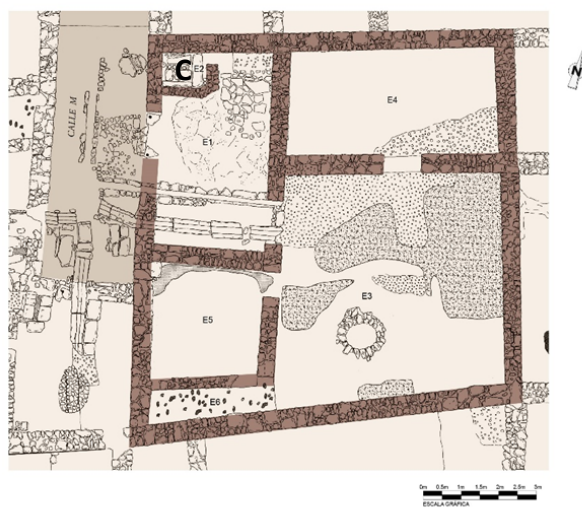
Huerta de Santa Isabel. Casa 123. Planta y distribución de espacios. Cocina (C).
